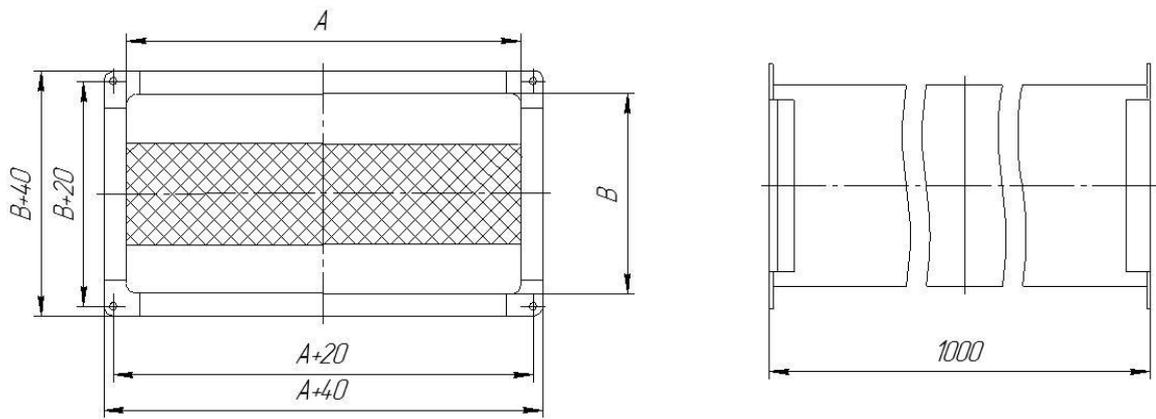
Внешний вид и габаритные размеры шумоглушителей RSS
